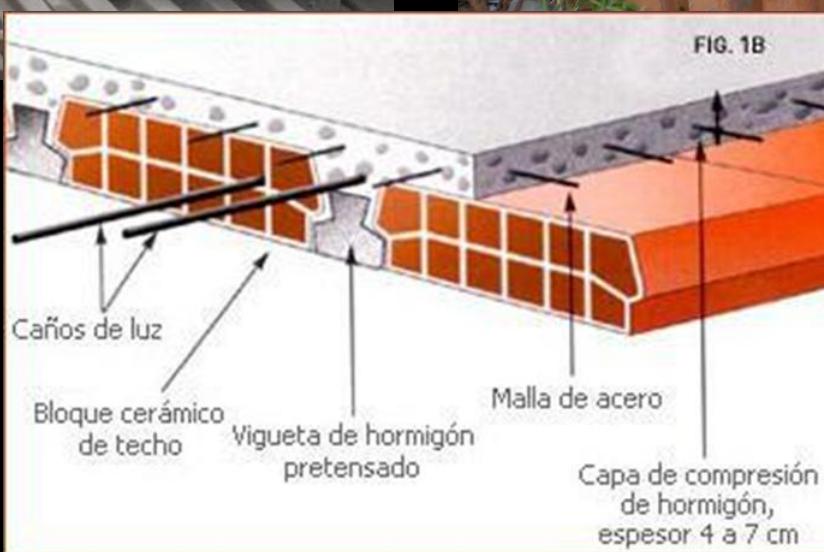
Sistema de losa sobre vigas maestras
